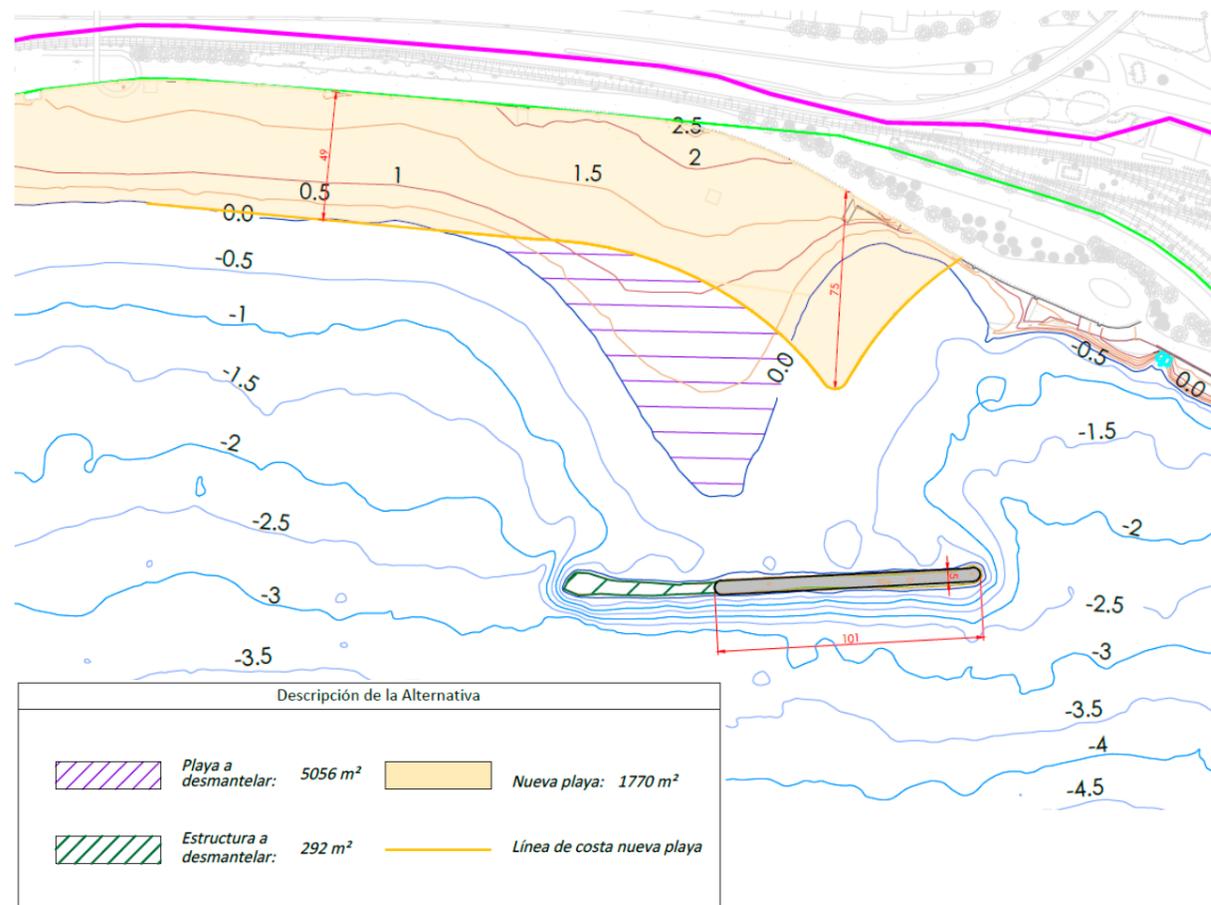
Configuración en planta de la Alternativa 1 del CEDEX.
